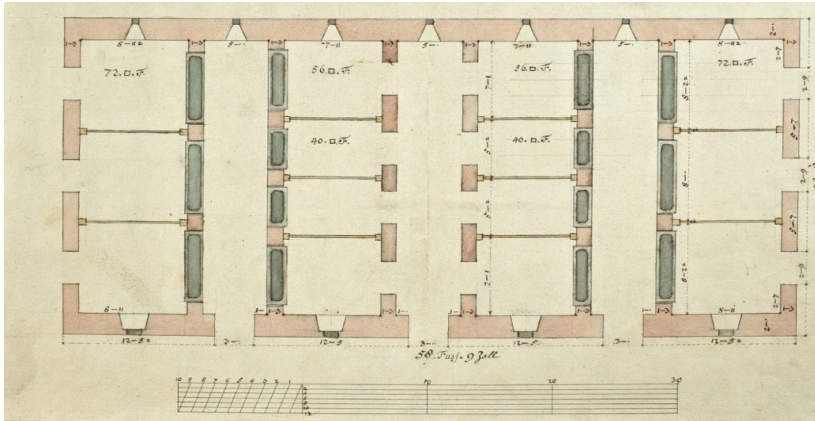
Ansicht und Grundriss eines Schweinestalles auf dem Gelände der Meierei mit Maßangaben, ca. 1750 (Ausschnitt). Halle, Franckesche Stiftungen. AFSt/A 16/01/07
